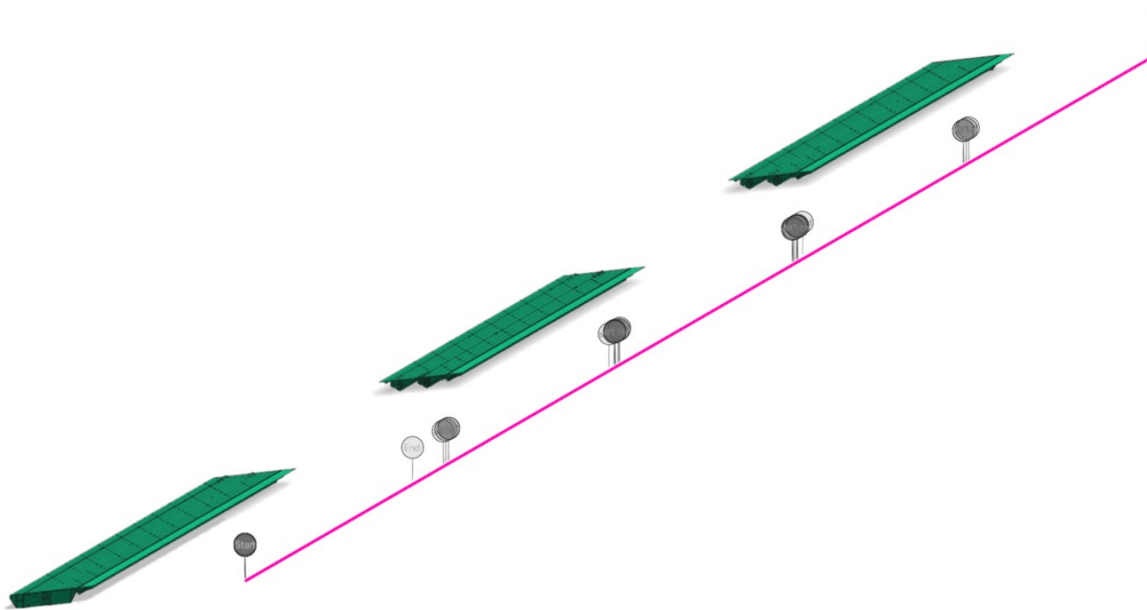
Assegnazione impalcato Padova, Venezia ed intermedio struttura in Acciaio ponte Nord
